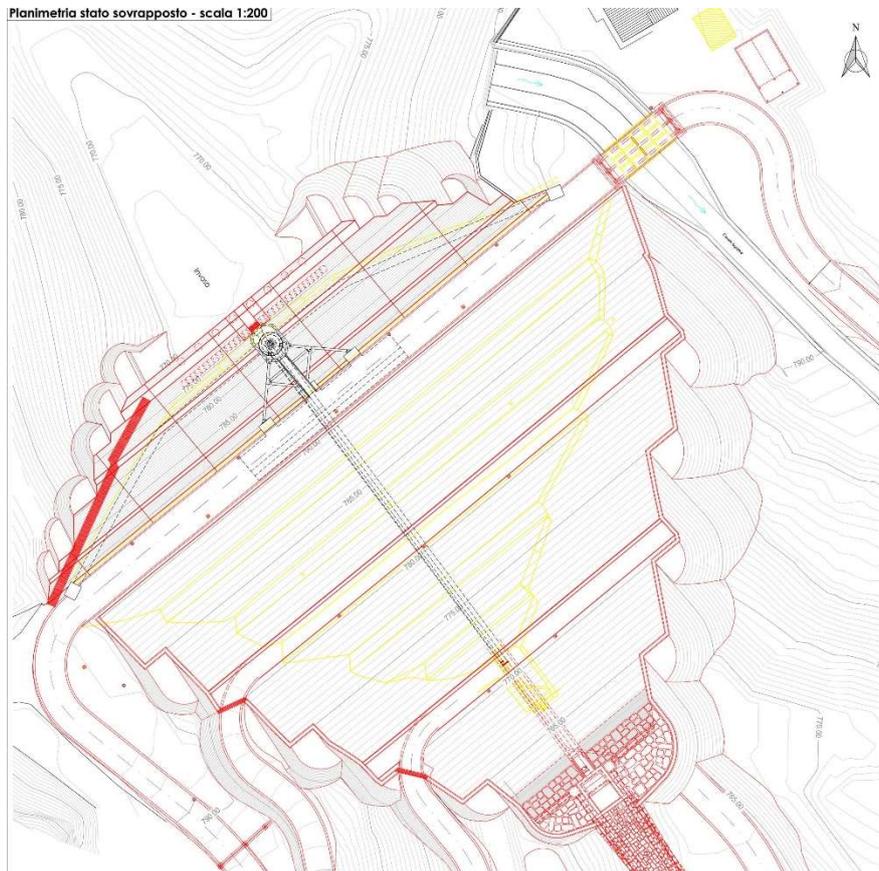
Estratto della planimetria dello stato sovrapposto dell'opera di sbarramento. In giallo lo stato attuale, in rosso gli interventi in progetto
